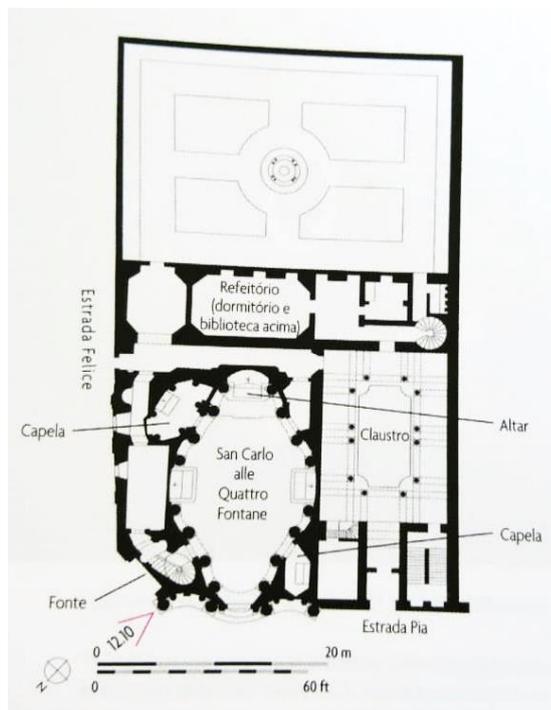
Igreja San Carlo alle Quattro Fontane, 1641, Planta baixa.
